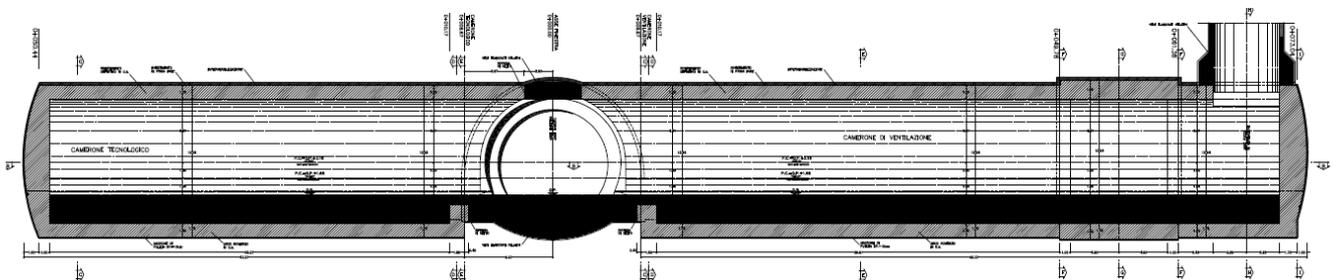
Sezione trasversale camerone tecnologico e camerone di ventilazione
